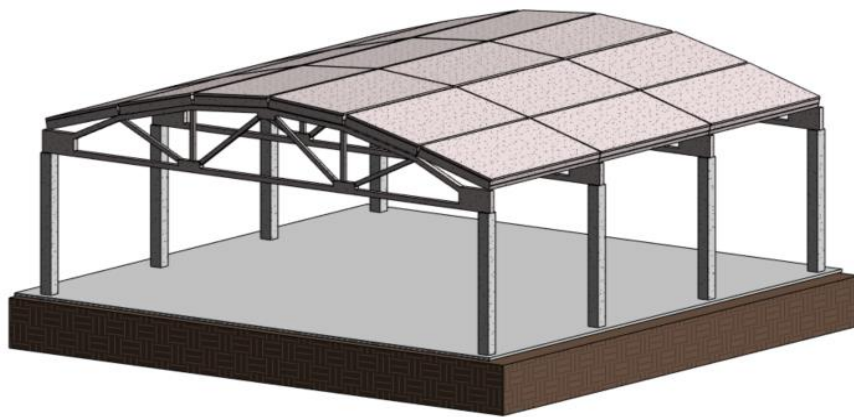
Каркасна конструктивна схема з 18 метровою розкісною залізобетонною фермою (варіант №2)
